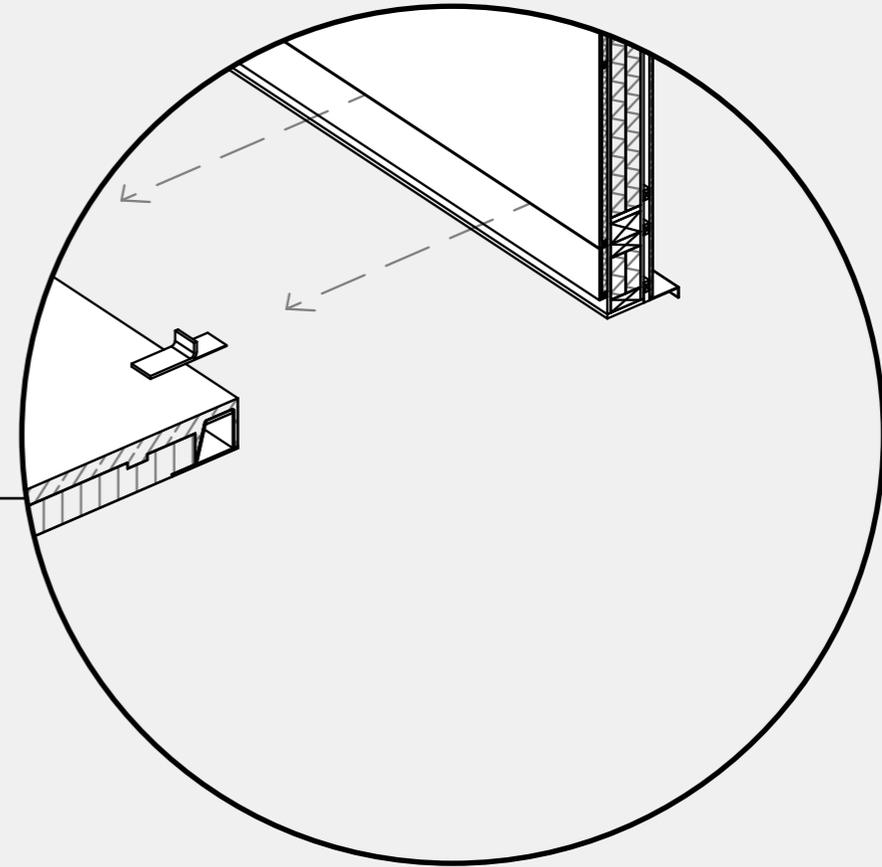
| Detailausschnitt der axonometrischen Konstruktionsdarstellung
